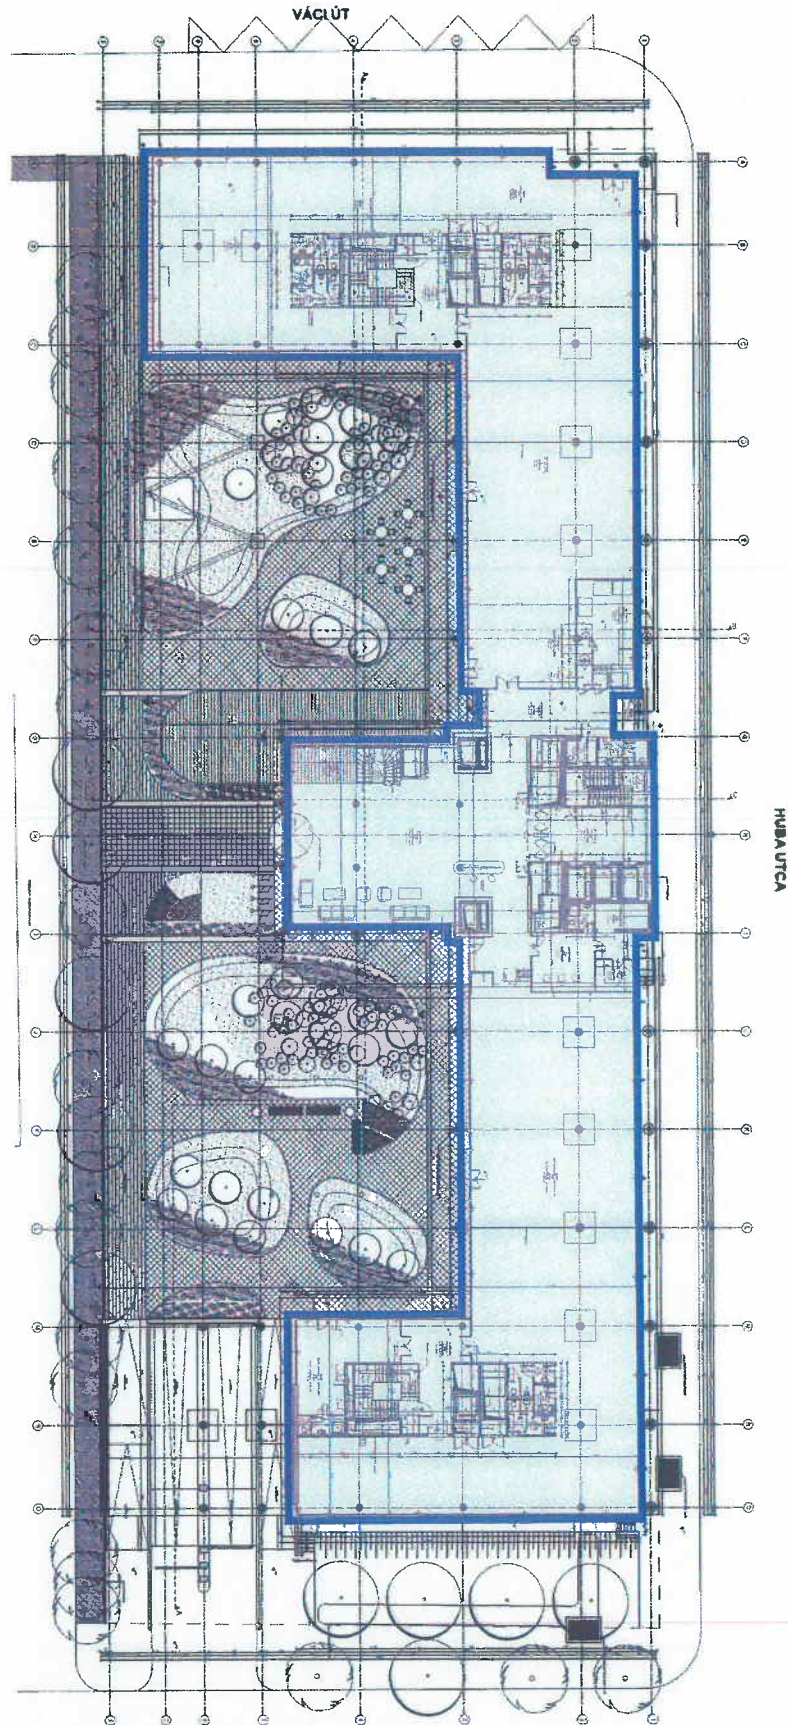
Grundriss des Erdgeschosses mit Eintragung der thermischen Hülle (blaue Fläche bzw. blaue Linie).
